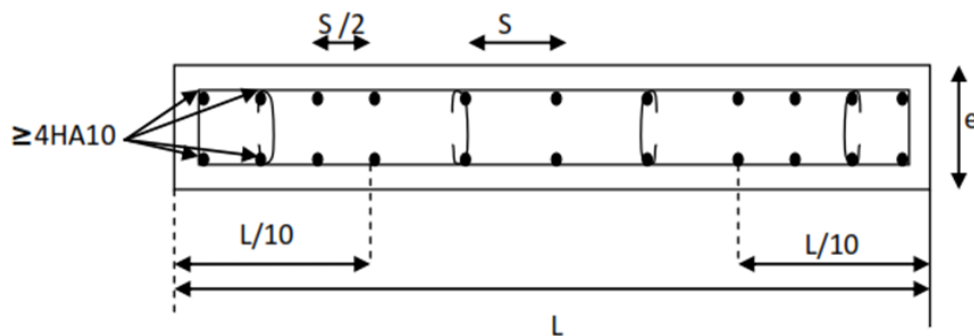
Disposition des armatures verticales dans les voiles.
